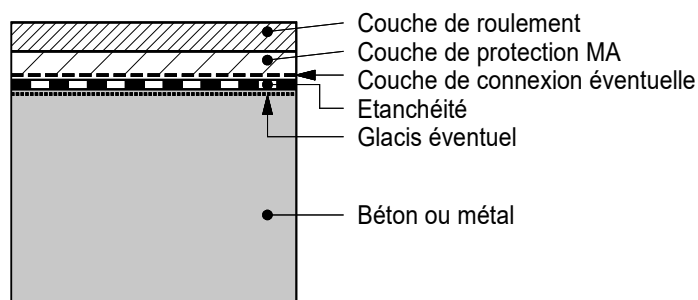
Schéma de la structure des systèmes d'étanchéité collée
